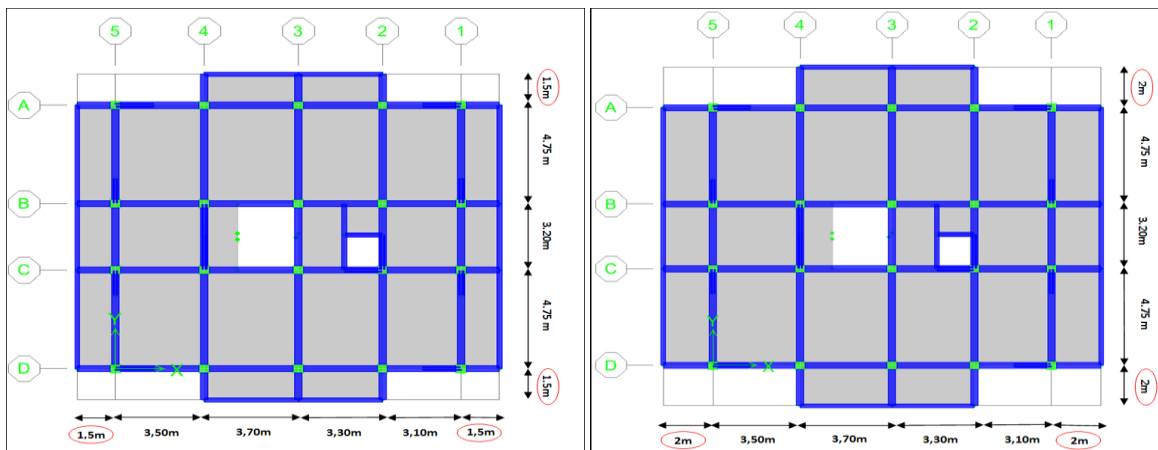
Vue en plan de la structure STR2 (1,5m). Figure IV.2 : Vue en plan de la structure STR3 (2m).
